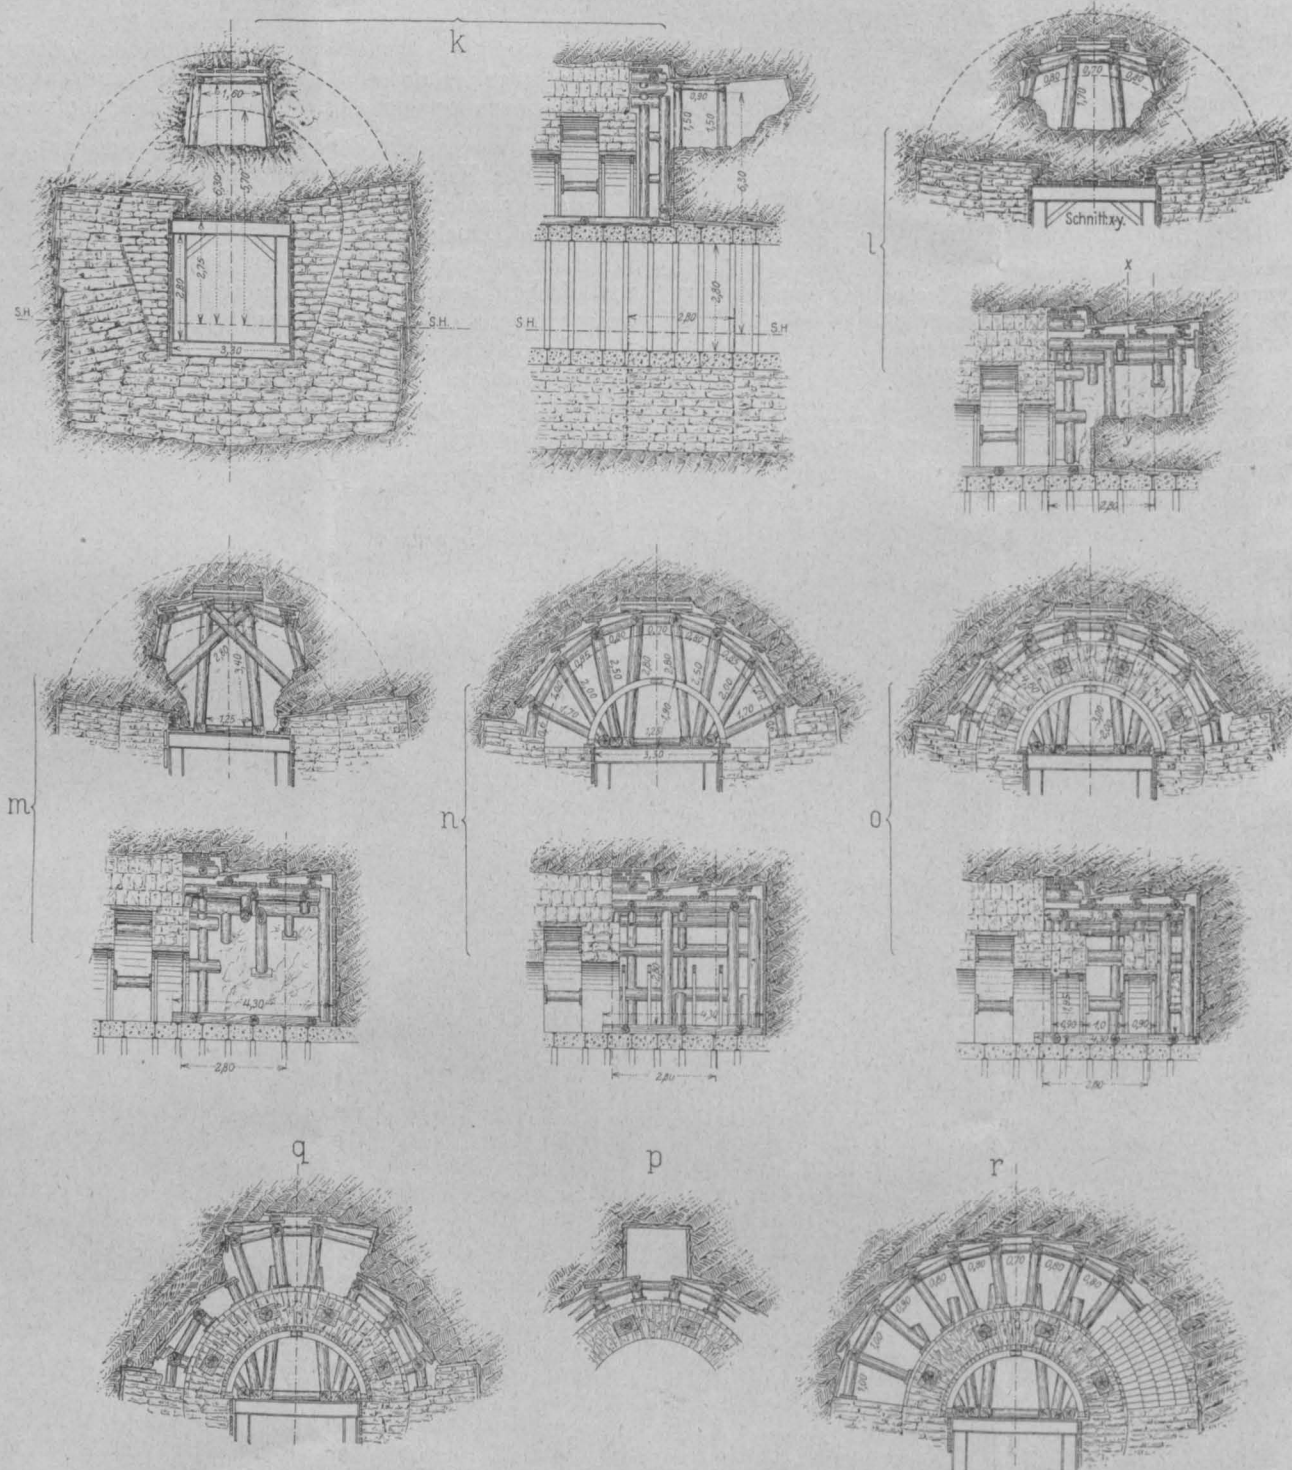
Druckstrecke im Tunnel I Südseite. Arbeitsvorgang bei Ausbruch und Mauerung des Gewölbes
